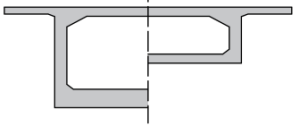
Puente Grau, Piura sección transversal, viga cajón de 3 células (Fuente: [29]).
